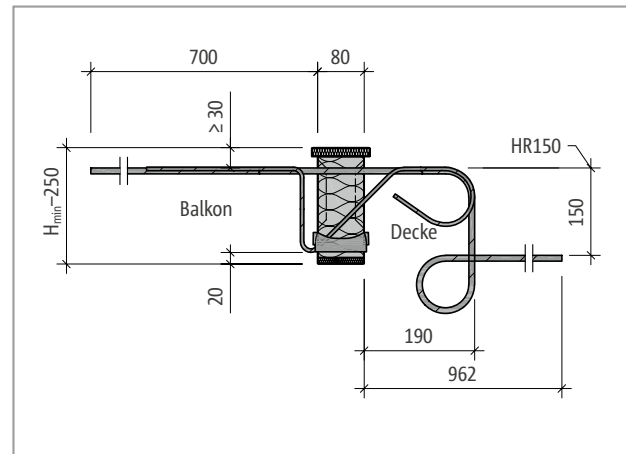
Schöck Isokorb® T Typ K-BH-M2: Produktschnitt
